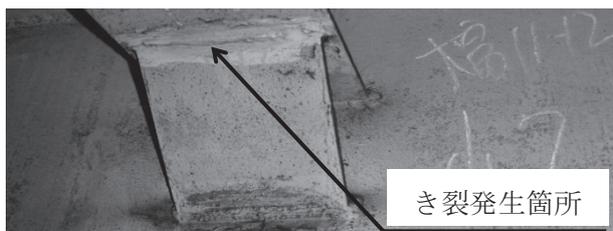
軌道桁隅角部補強溶接部のき裂
